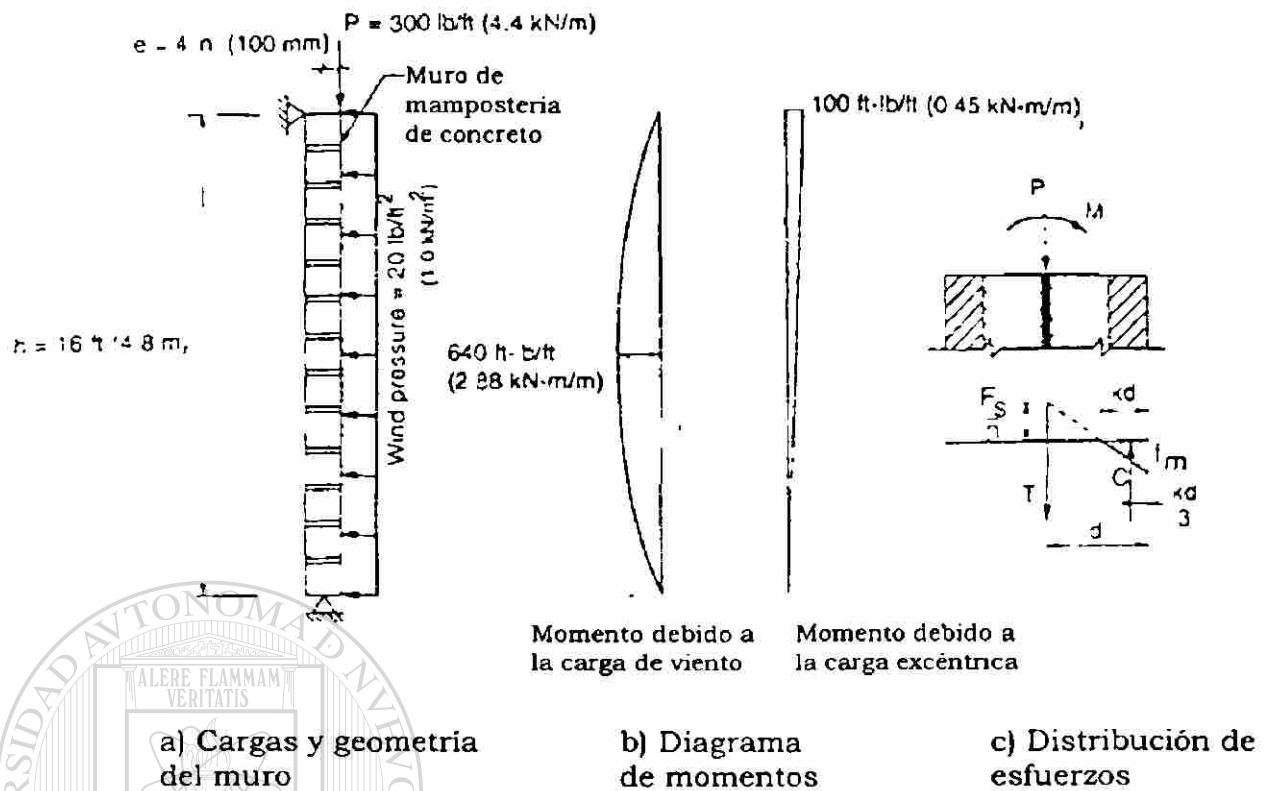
Muro de mampostería reforzada del ejemplo 5.1
